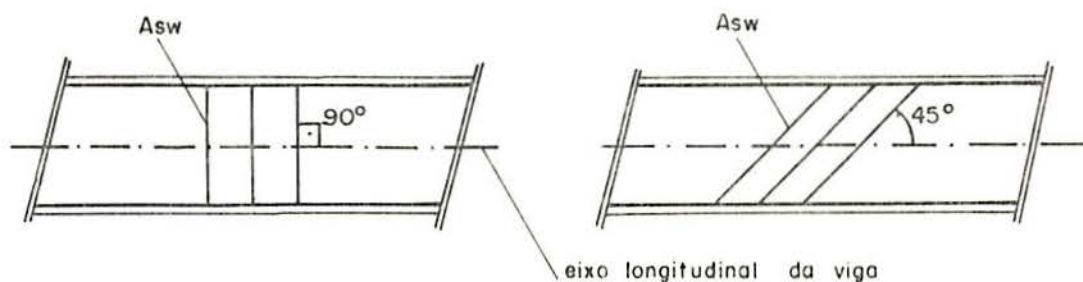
Estribos em Vigas (ângulos de inclinação)
